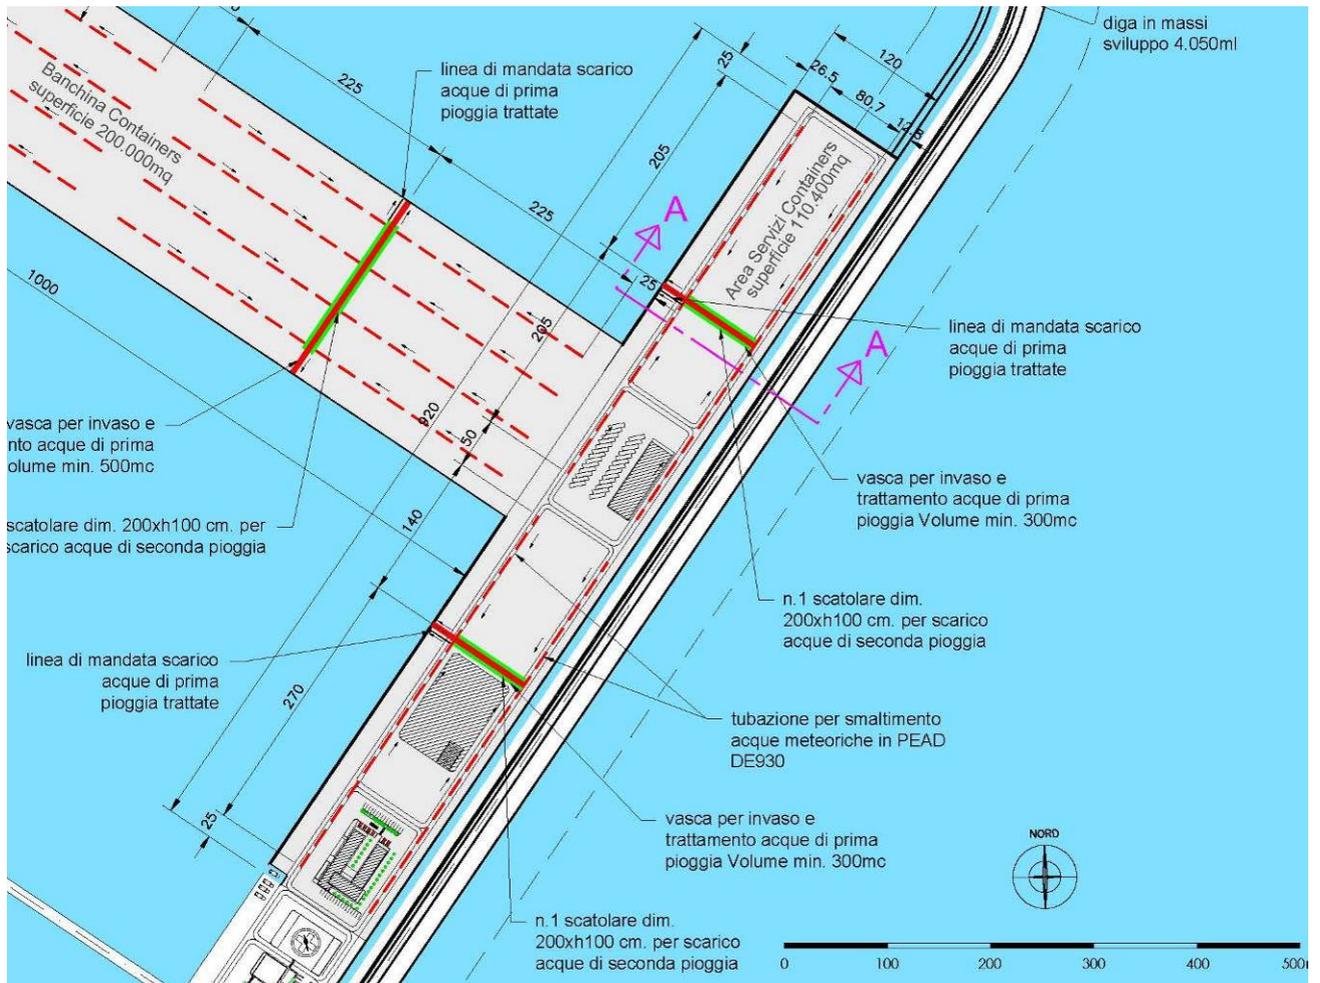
Banchina servizi – planimetria rete di smaltimento acque meteoriche.
